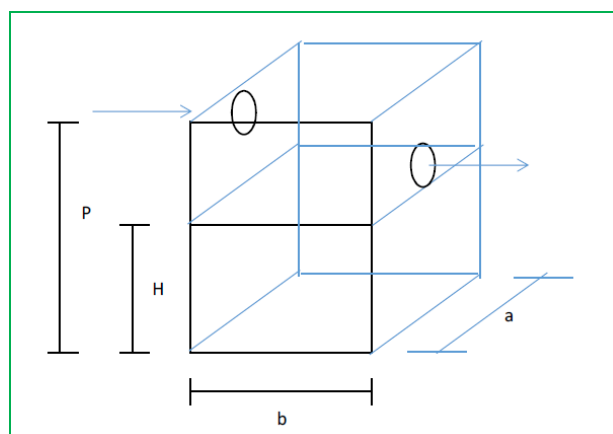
Detalhe Caixa de Gordura e dimensionamento.
